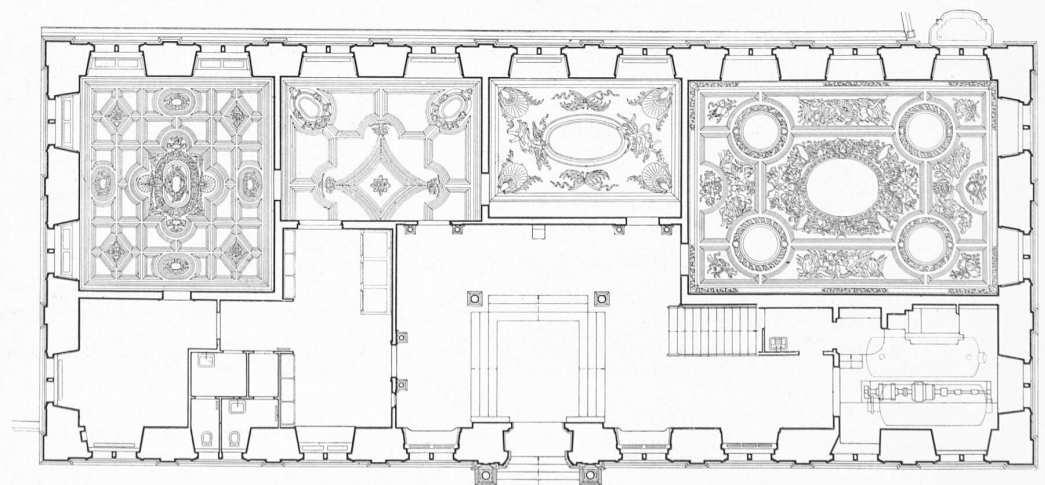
Grundriss des Erdgeschosses 1 : 250
